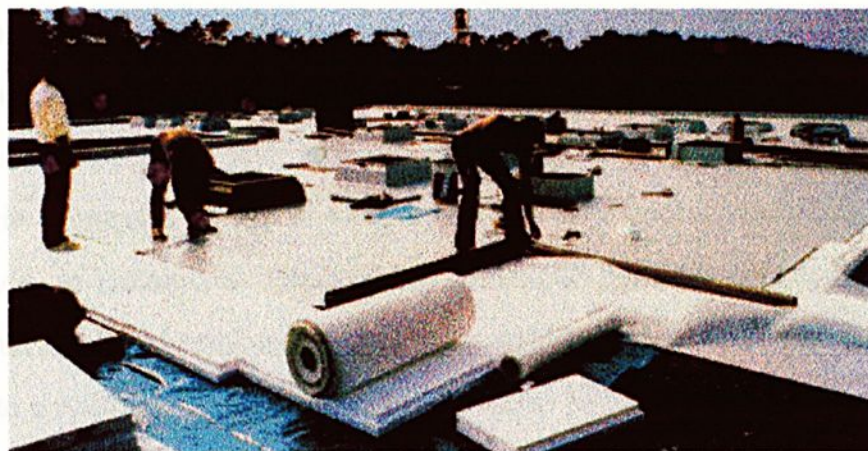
Laje impermeabilizada com placas de EPS para isolamento térmico [BASF, s.d.]
